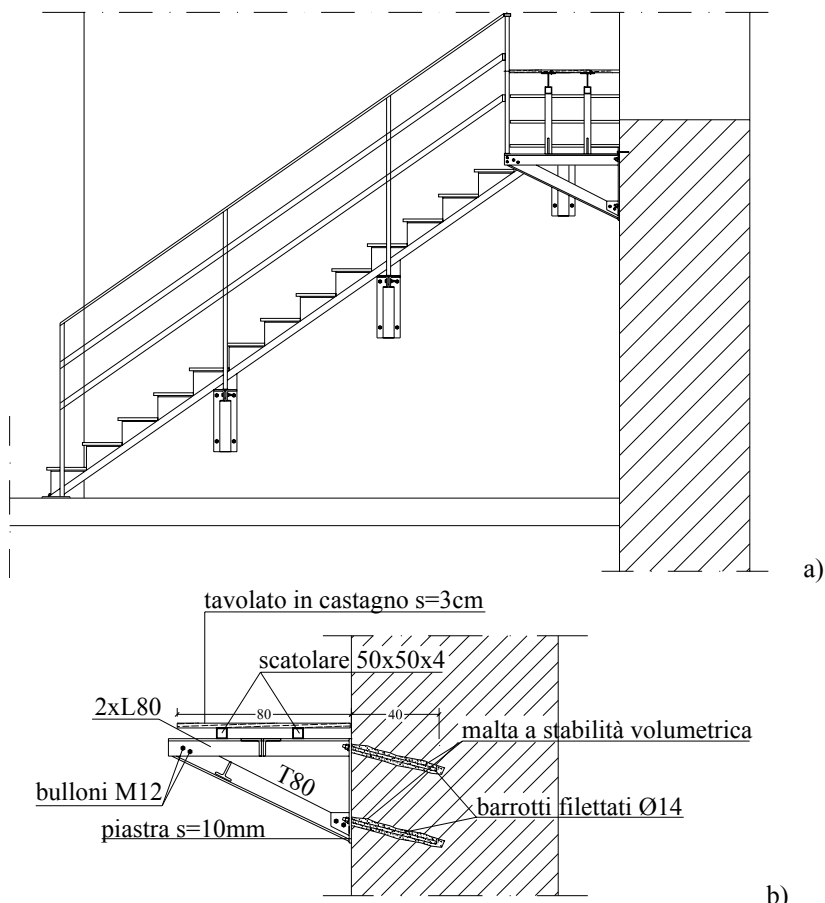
Scale di accesso ai servizi e al sottotetto: a) Prospetto prima rampa; b) Particolare.
